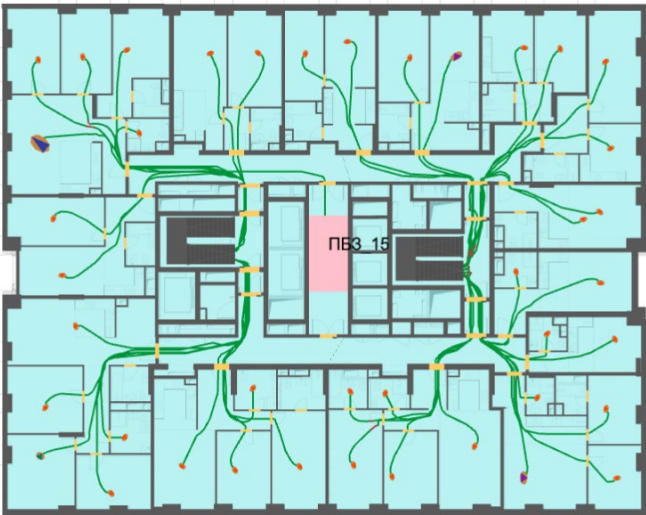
План 15-го – 31-го этажа и нанесенная на него расчетная (принципиальная) схема эвакуации
